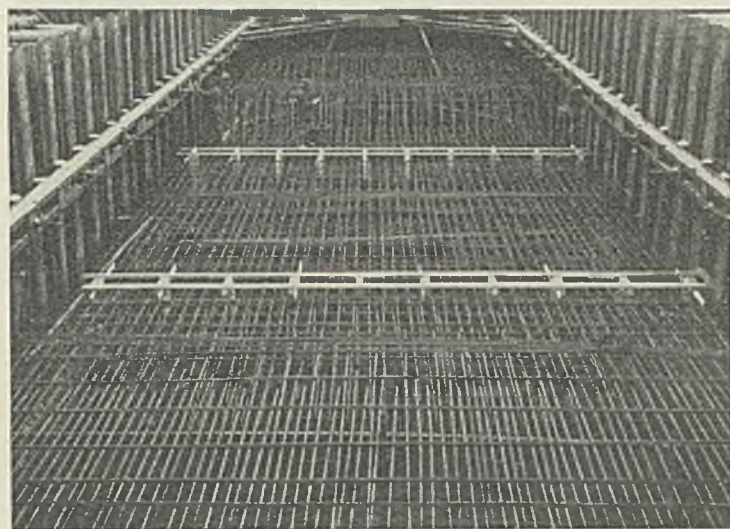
Zellaussteifung und Rundeseisenbewehrung Außenhaupt — Block 3.
